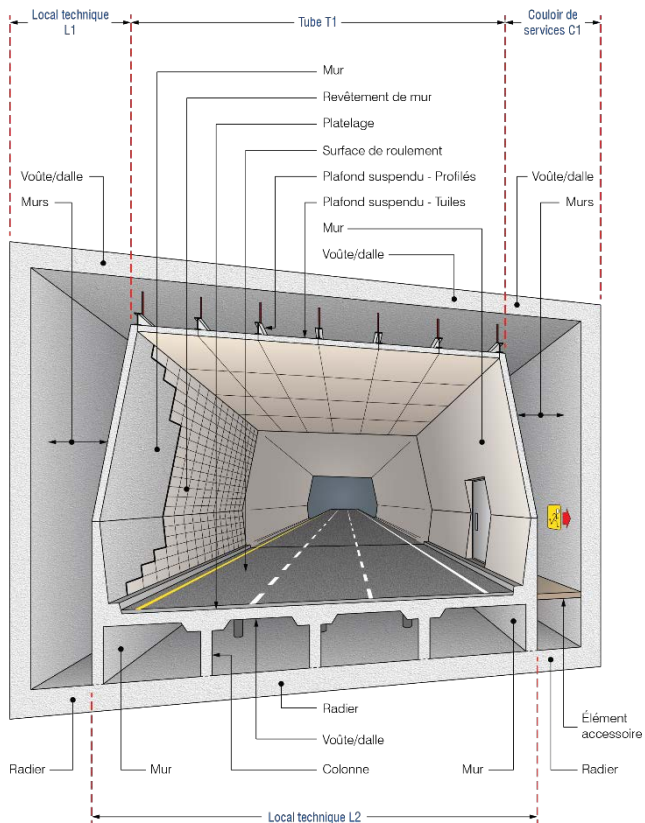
Largeur totale d'une section de tunnel constituée de plusieurs tubes
